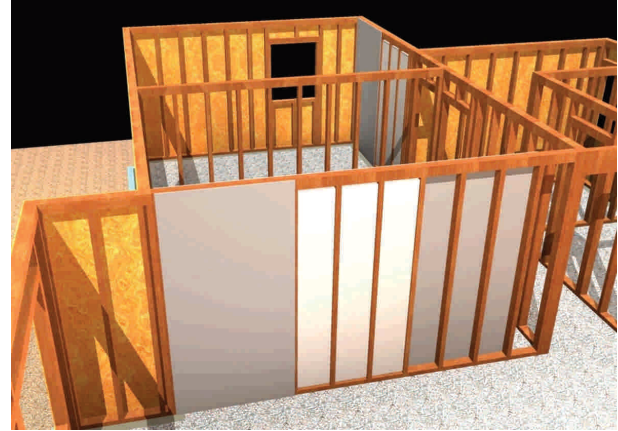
3 El control geométrico de cada elemento que se instala debe ser rigurosamente inspeccionado.
